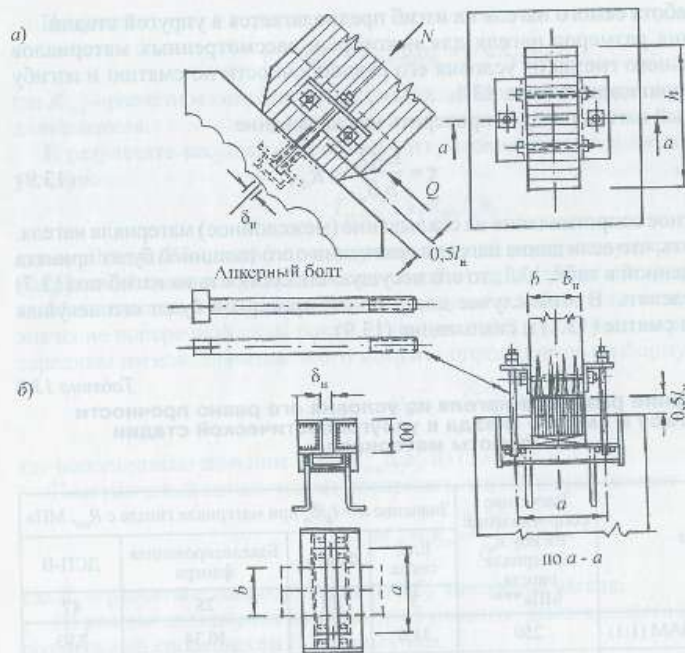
Конструкция опорного узла арки с применением полимерных материалов: а – общий вид опорного узла; б – конструкция закладной детали и ее анкеровка
